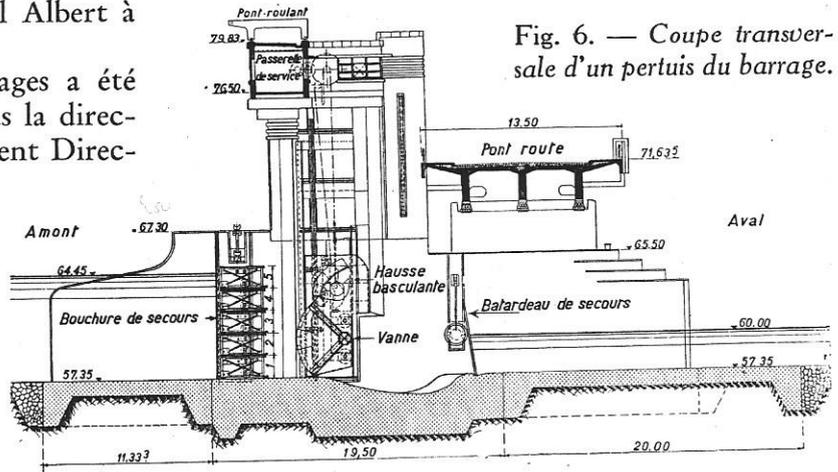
Coupe transversale d'un pertuis du barrage.
